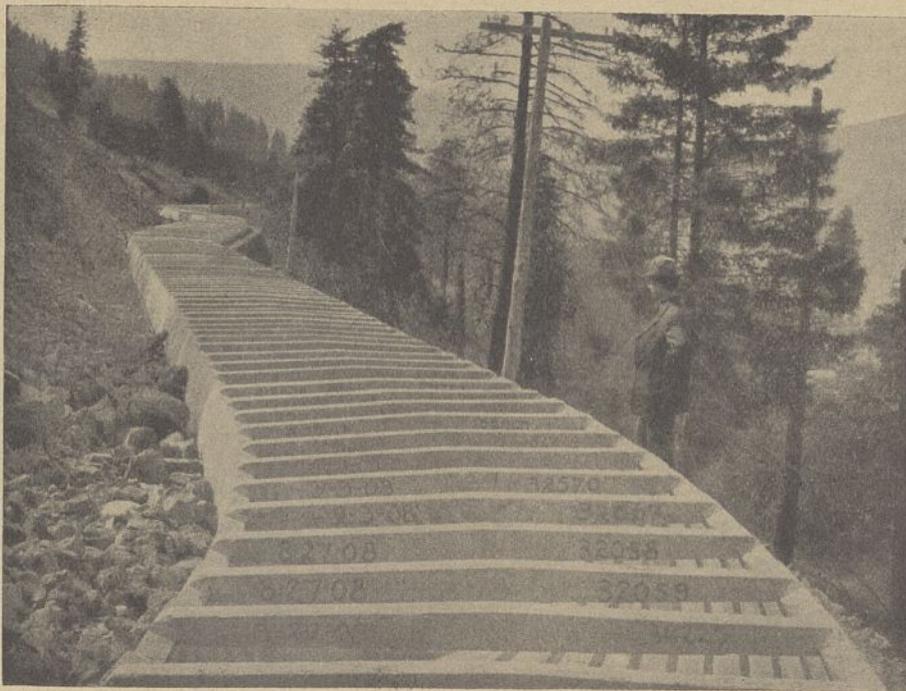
Betonierter Lauf des Tieton-Kanals. Yakima-Projekt in Washington.
